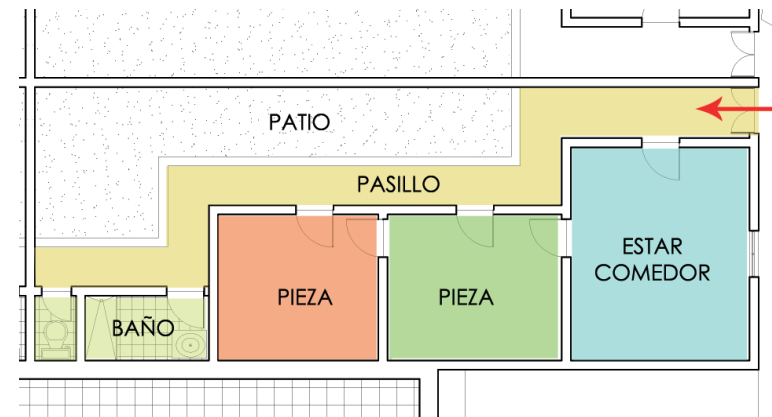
Planta vivienda tipo, zonificaciones y acceso desde el exterior.
